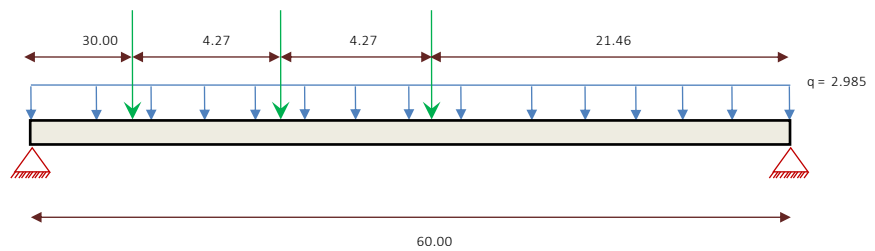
Tren de cargas vigas en acero camión HS-MOP
